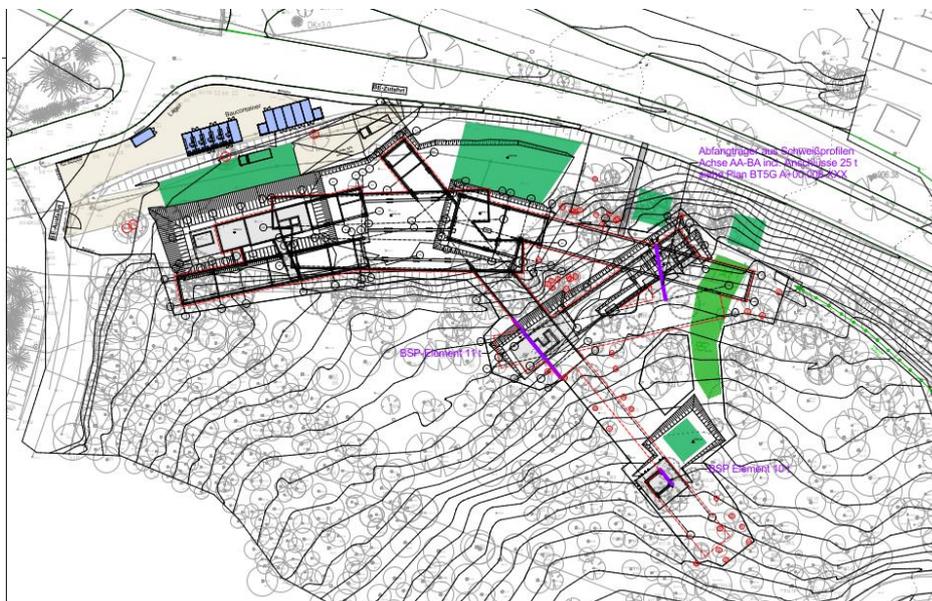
Baustelleneinrichtungsplan Bauherr, Quelle: Ausschreibungsunterlagen BH
